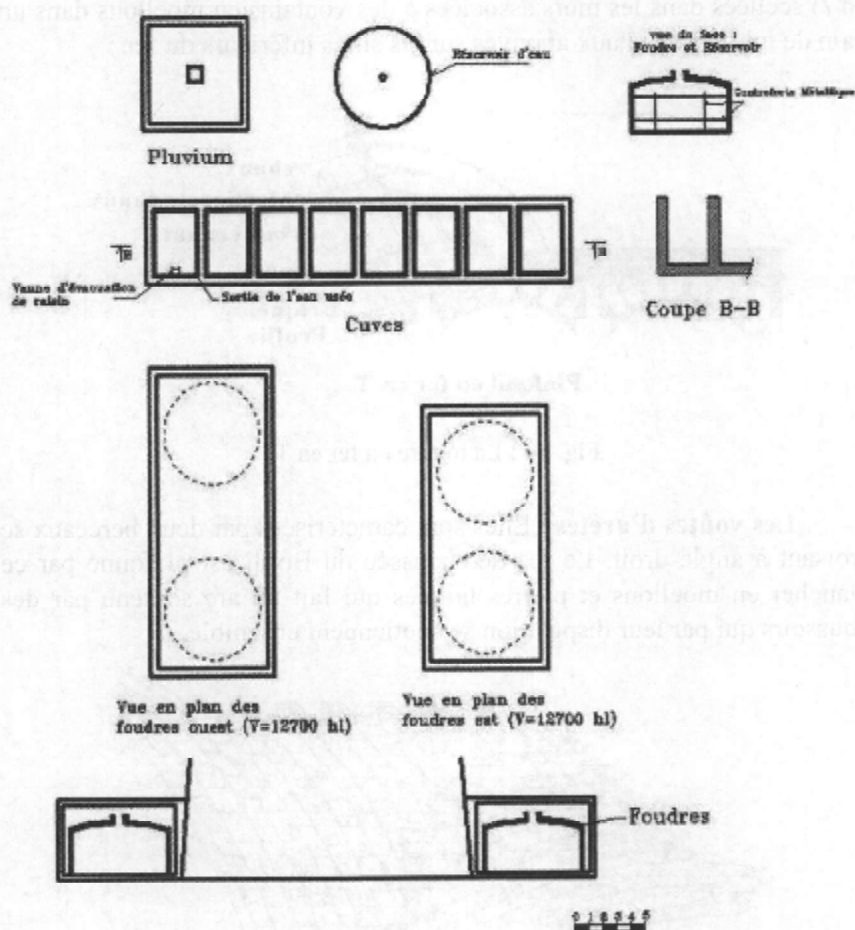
Les foudres au premier plan au contrebas des cuves.
